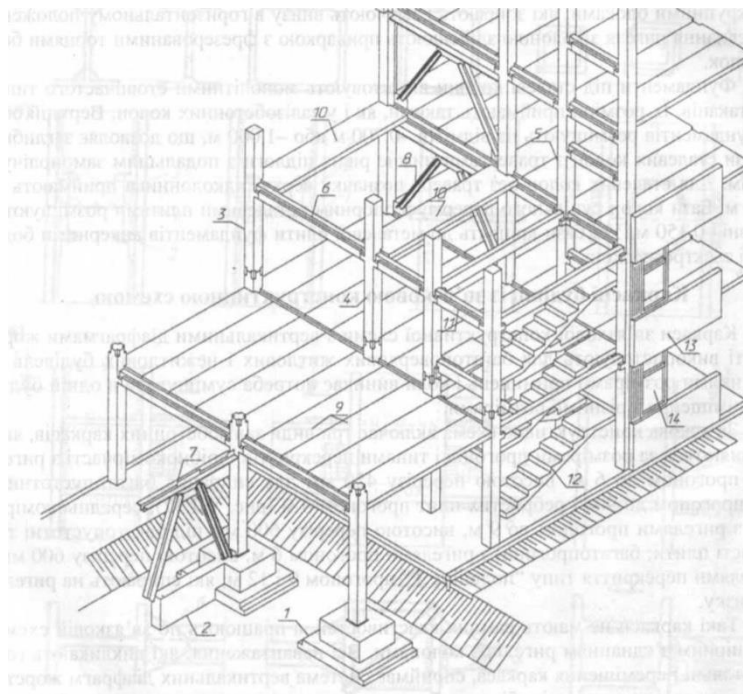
Основні елементи багатоповерхової промислової будівлі із зв'язковим залізобетонним каркасом:
